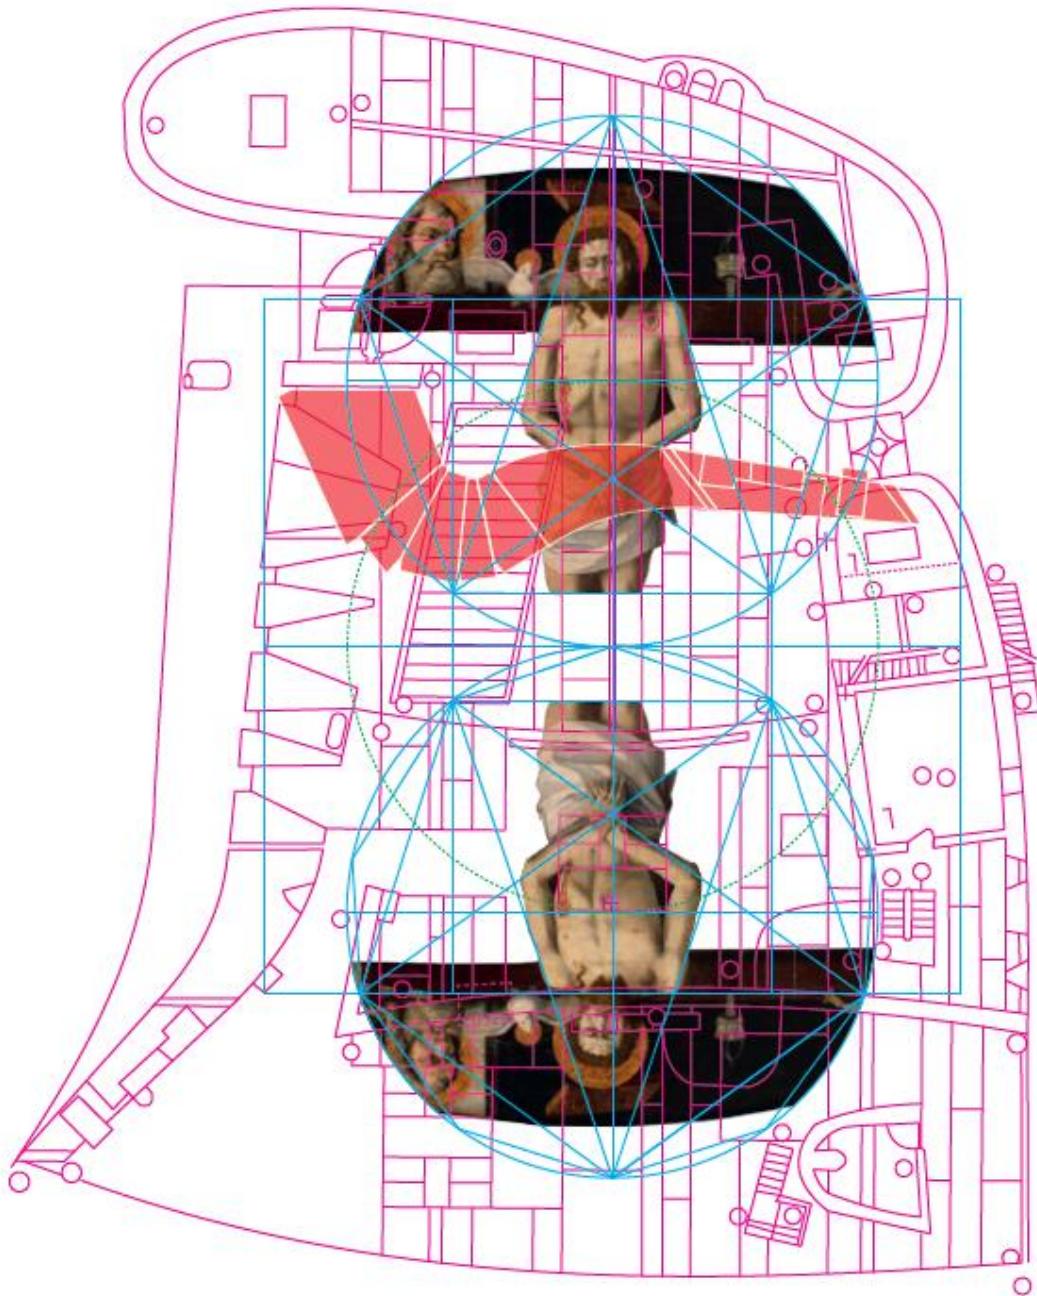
Planimetria con sovrapposizione del tracciato regolatore - muro virtuale parte del Retablo parziale.
